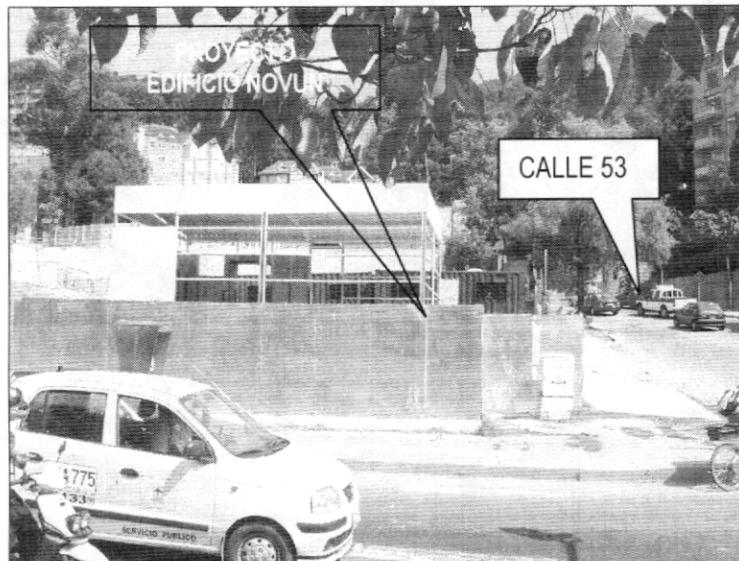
Aspecto del predio donde se llevará a cabo el proyecto de la Calle 53 No. 3 - 04
